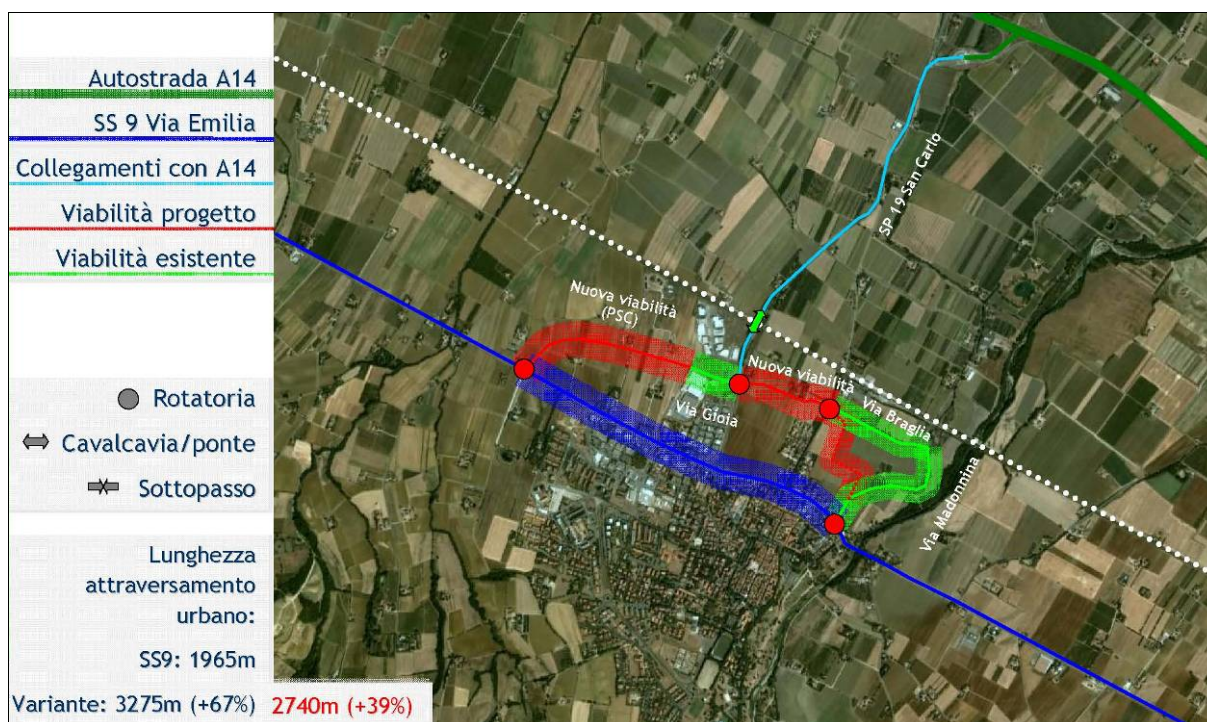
Variante di Castel San Pietro: ipotesi di minima (e alternativa)
